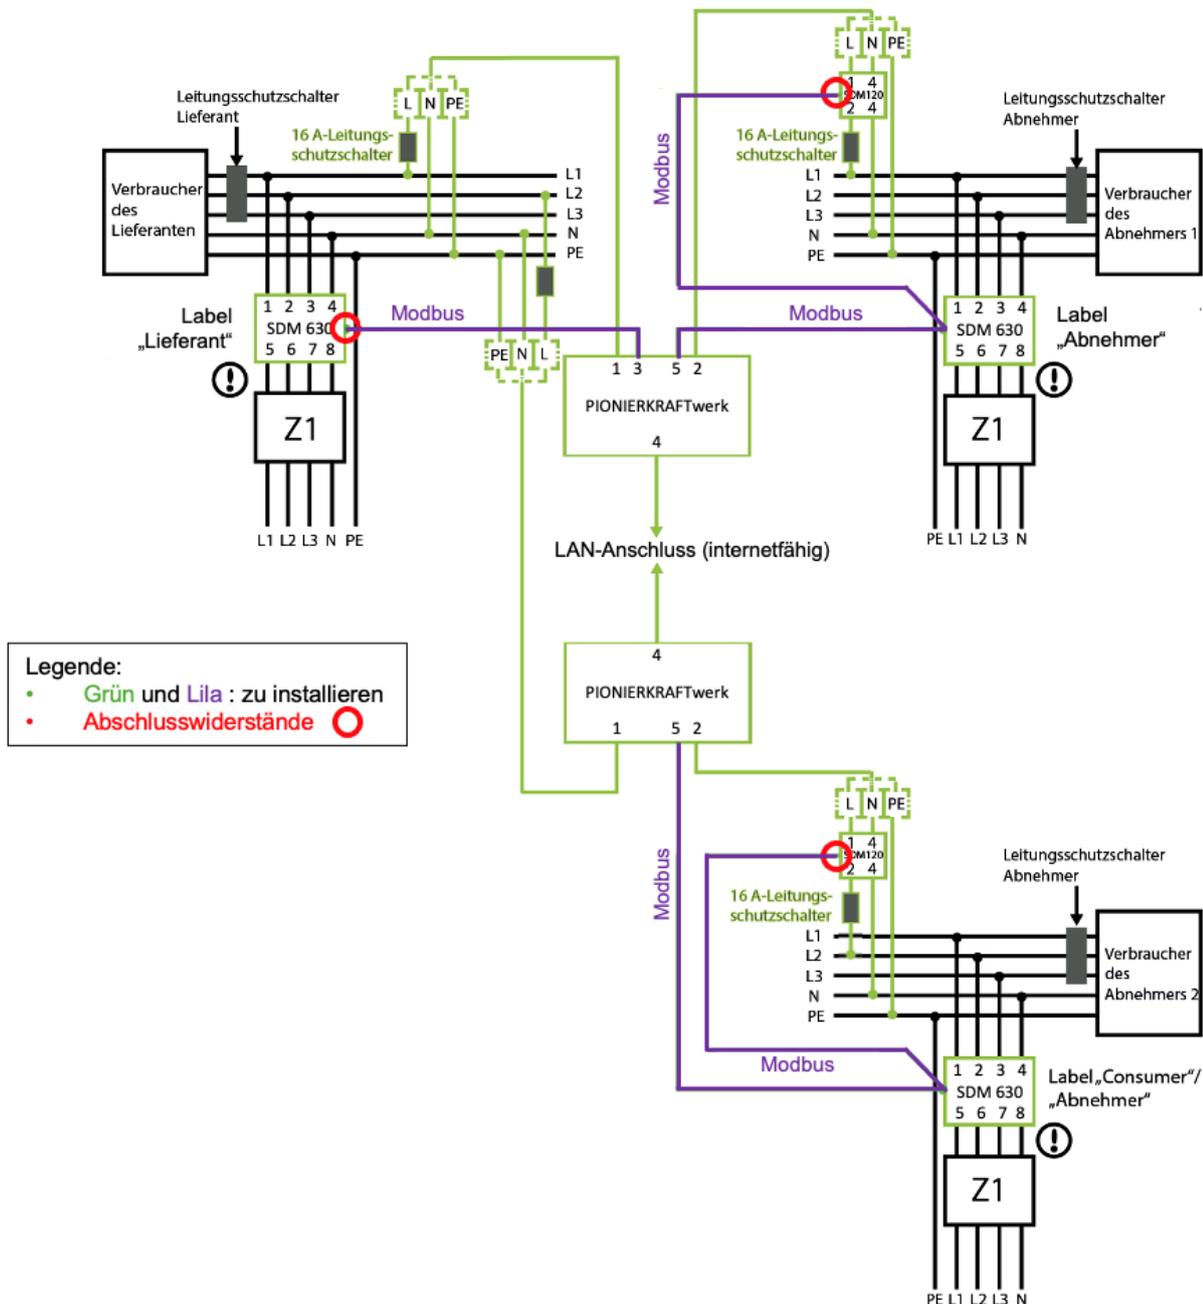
Installationsplan bei zwei oder mehreren PIONIERKRAFTwerken
